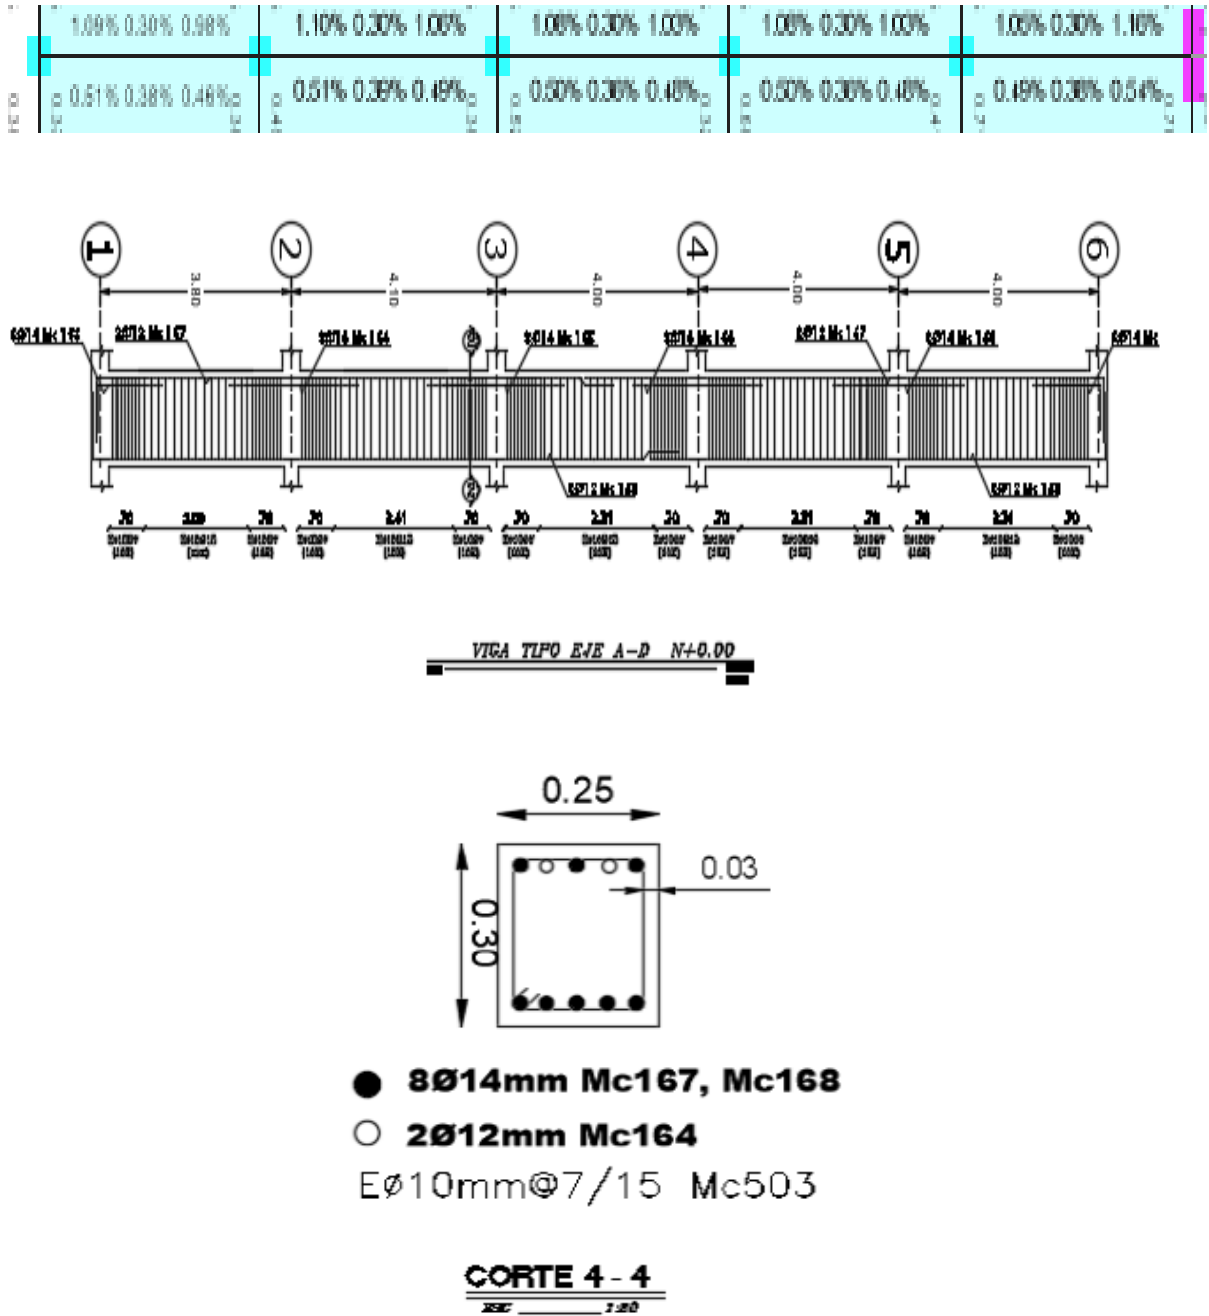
Porcentaje y armado de viga más demanda en el eje X
